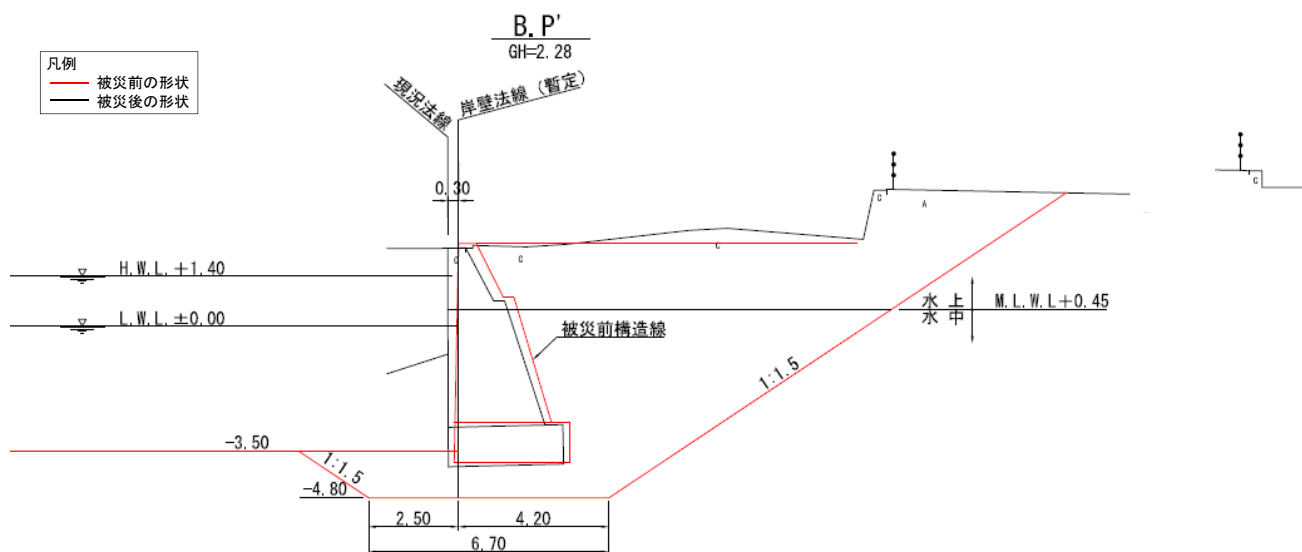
No. 5 海浜第1期正面護岸の断面図 B.P' (被災後)
